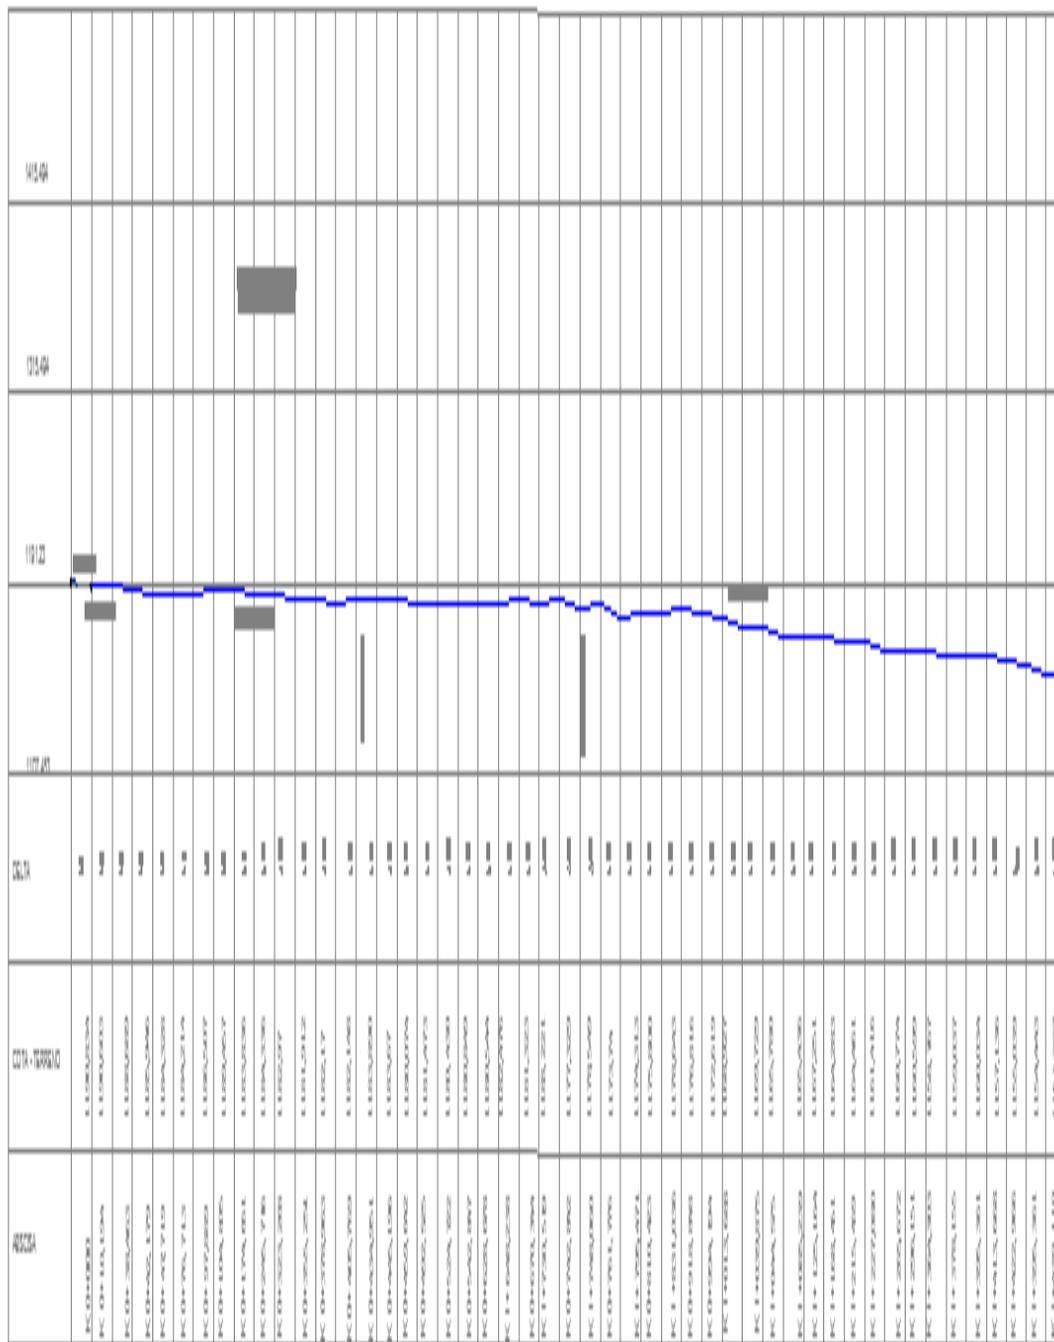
Perfil de la línea de aducción bocatoma-desarenador-tanque.
